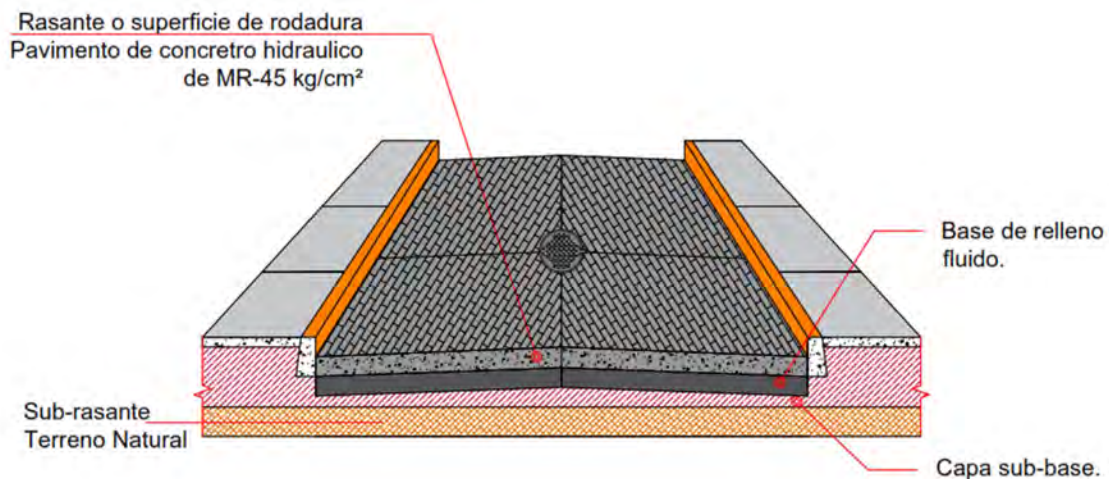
1 Sección especificando las capas que conforman un pavimento rígido.
